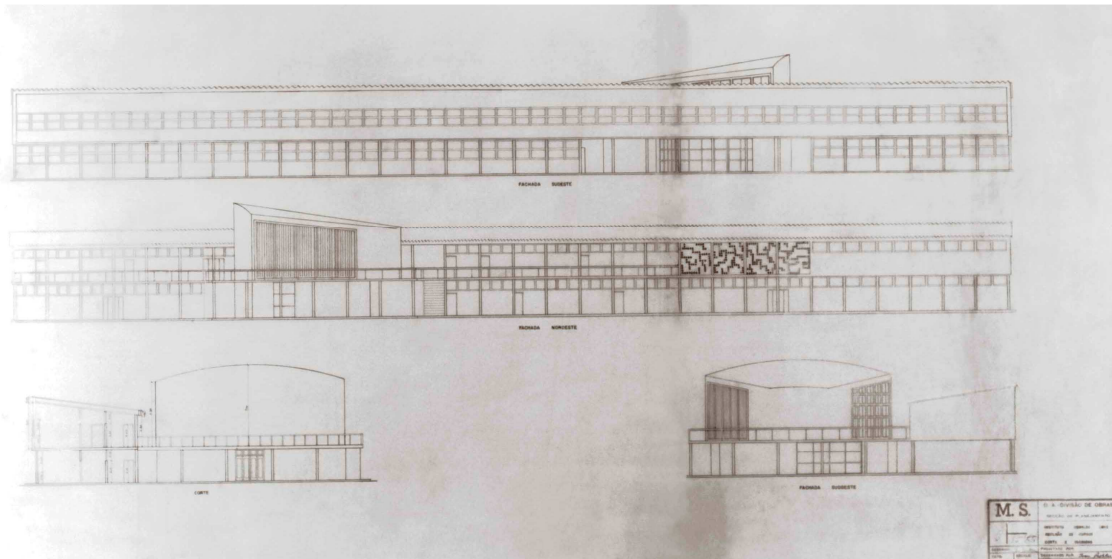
Planta das fachadas do Pavilhão de Cursos. 1955. Acervo DAD/COG.
